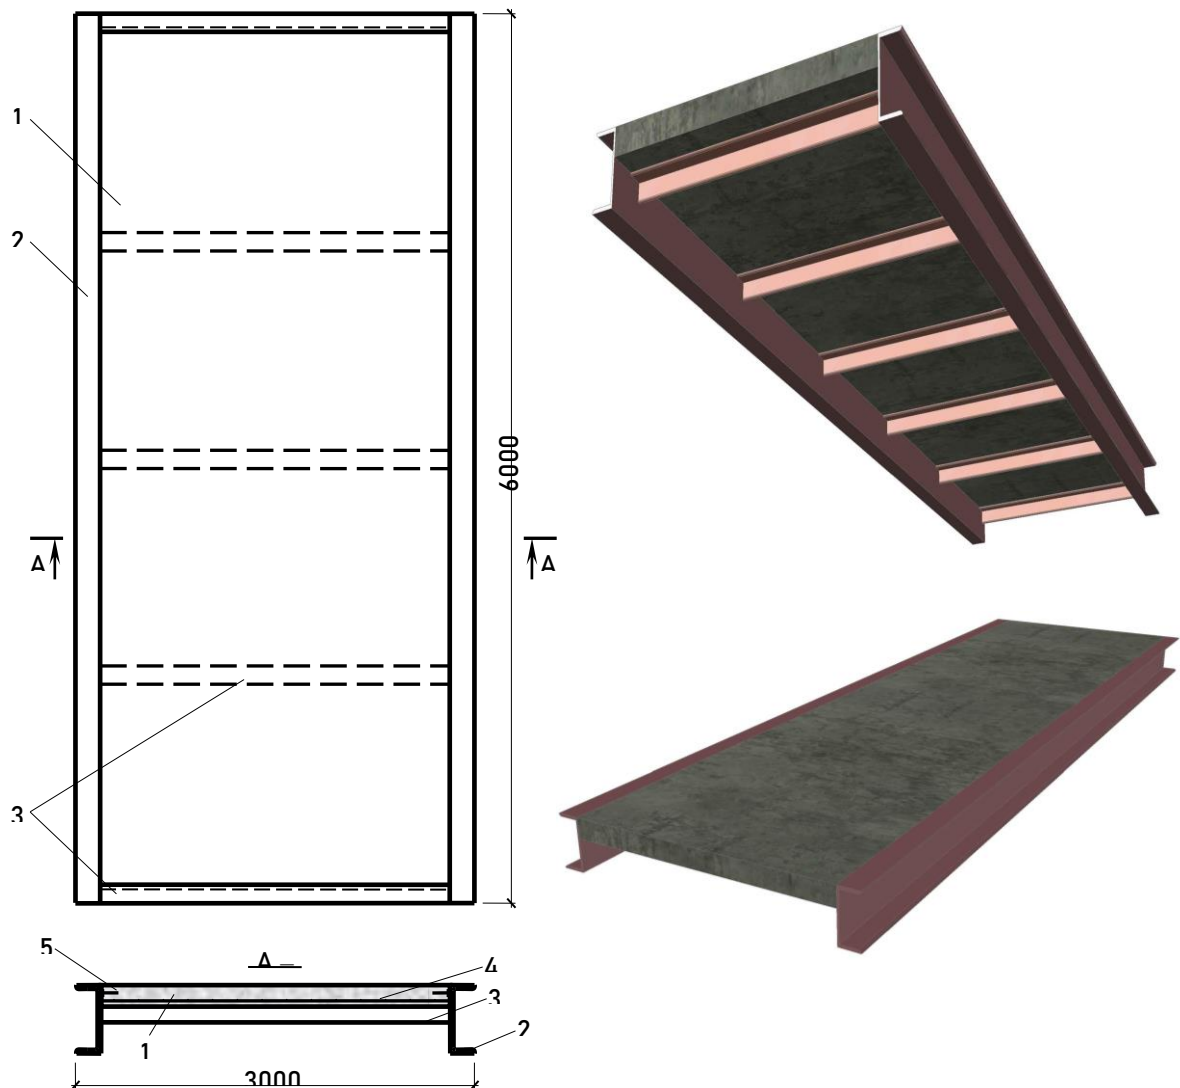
Збірна комплексна залізобетонна плита перекриття з підсиленням сталевими профілями:
